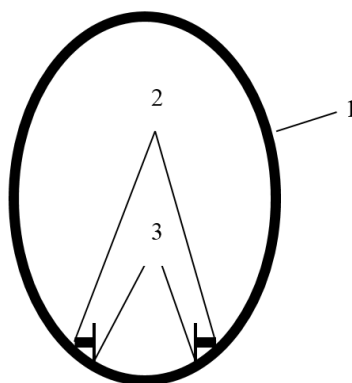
Поперечный разрез тоннельной части: 1 – поперечное сечение тоннеля; 2 – продольный вырез; 3 – колея
